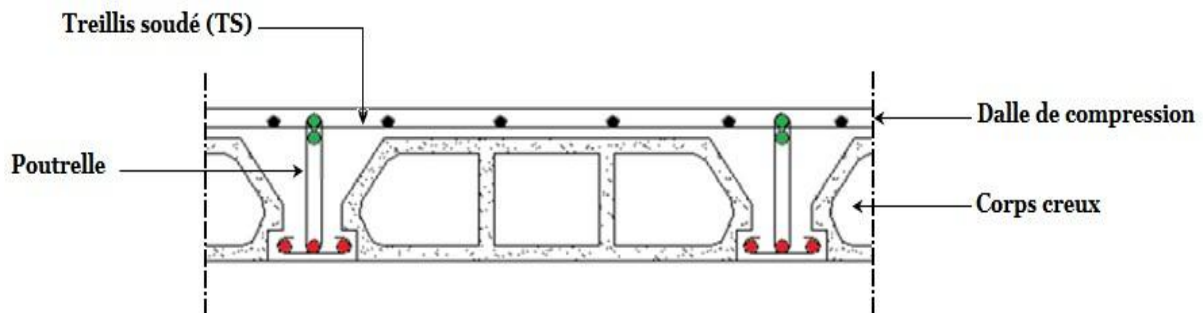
Coupe transversale d'un plancher à corps creux.
